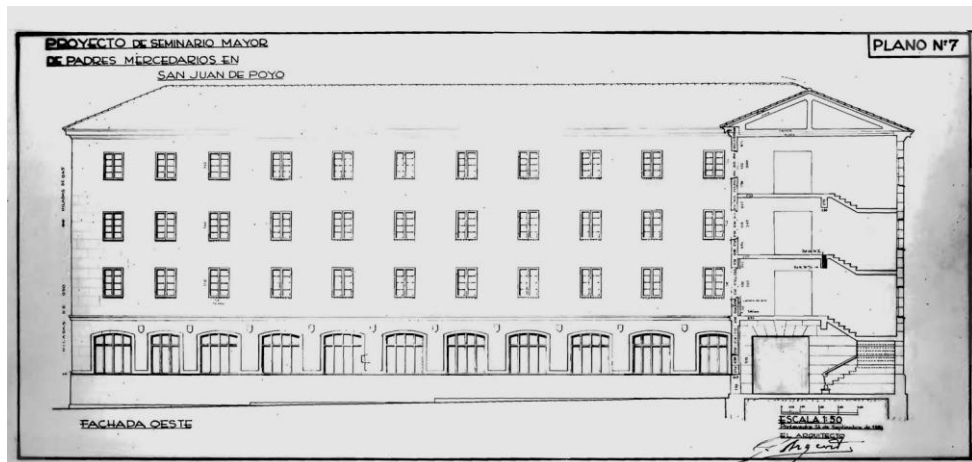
Fachada Oeste. Fuente: Archivo Provincial.
